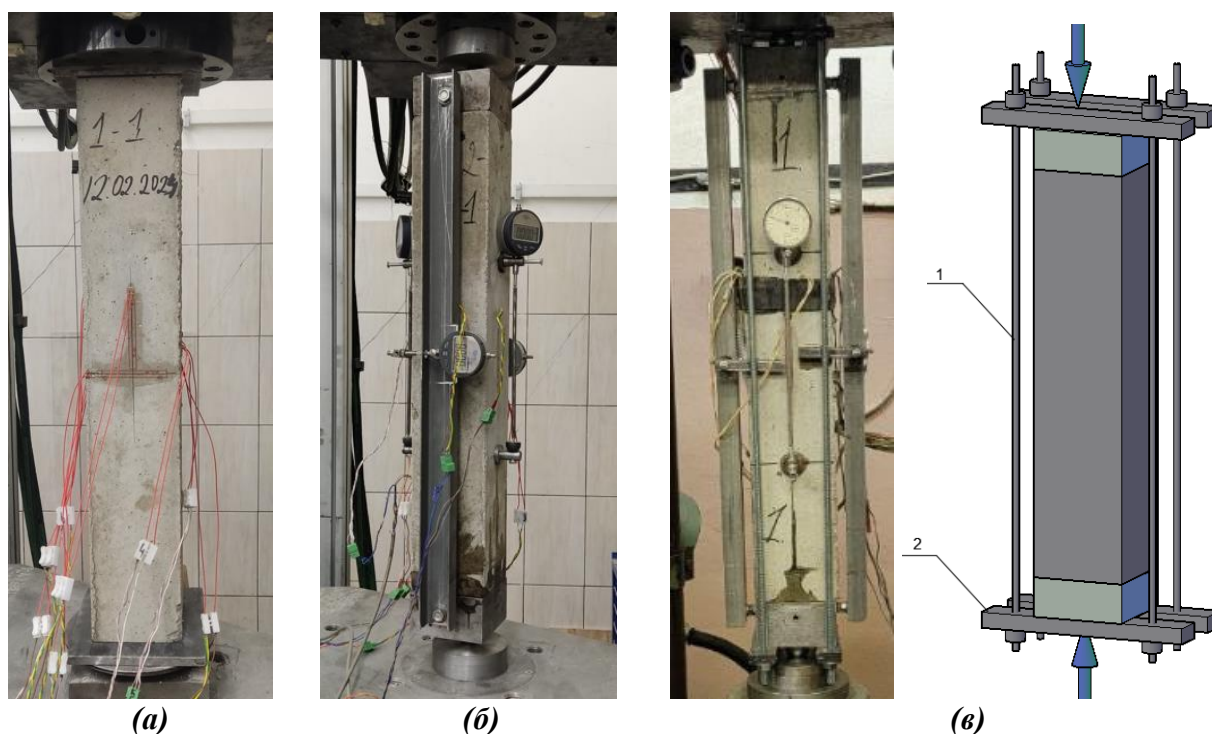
Общий вид железобетонных элементов в универсальной машине INSTRON 1000 HDX при испытании на квазистатический режим нагружения а) центральное сжатие б) внецентренное сжатие; оснастка для ограничения деформаций растяжения в железобетонных образцах после снятия длительной статической нагрузки в): 1 – шпильки, натягиваемые с помощью гаек; 2 – стальные пластины
